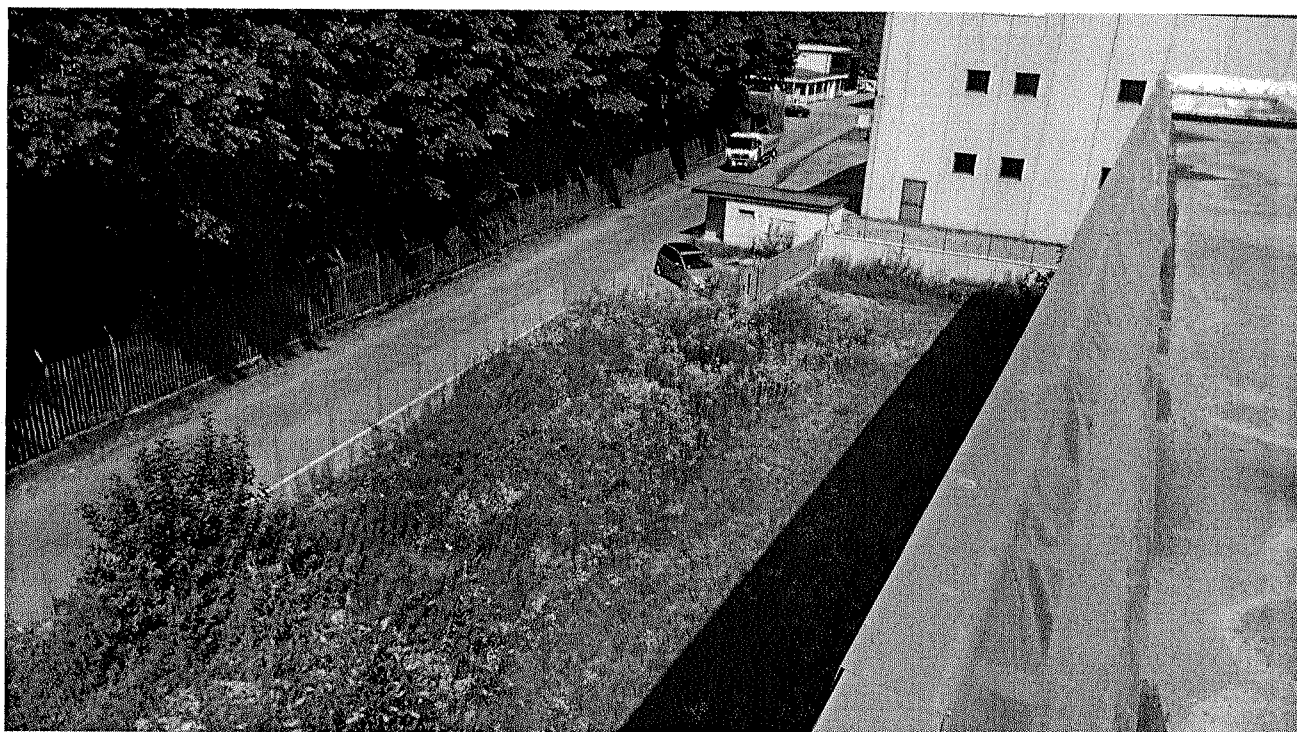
vista recinzione lato ovest – via Lombardia
